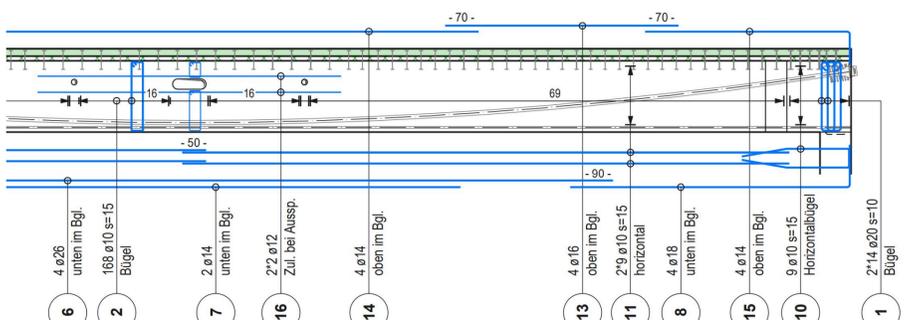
Biege- und Querkraftbewehrung des Trägers - Ansicht
